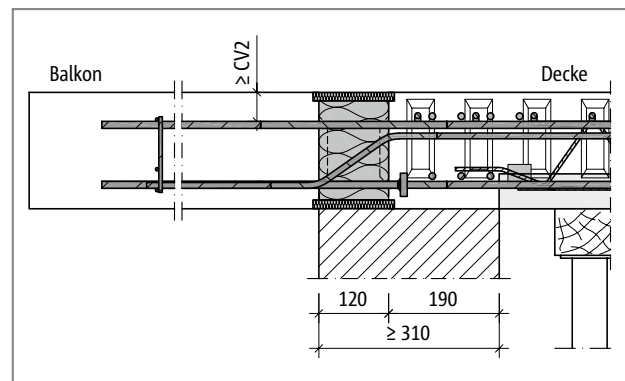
Schöck Isokorb® XT Typ CL: Elementplatte mit Randunterstützung mit wärmedämmendem Mauerwerk (Schnitt XT Typ CL-R-CV2, Ansicht XT Typ CL-L-CV1)
